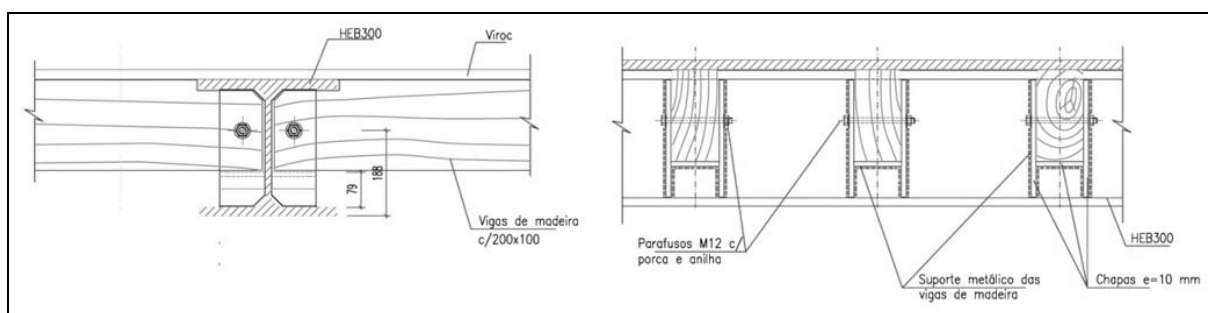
Pavimento de madeira e aço (zonas secas) [99]
